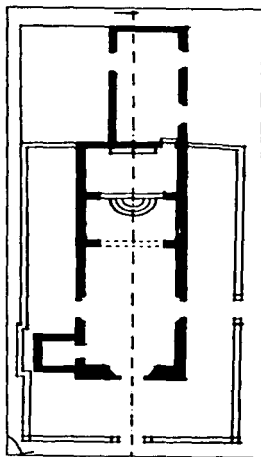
(03) Planta. Capilla San Antonio, hacienda Kakaina, Mpo. Tzucacab, Yucatán, 1866-1877.
